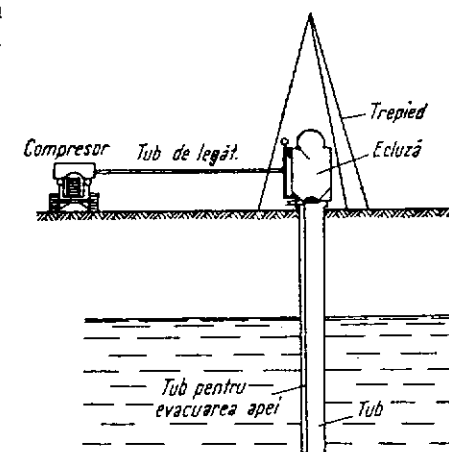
Schema instalației pentru executarea piloților Wolfholtz.
